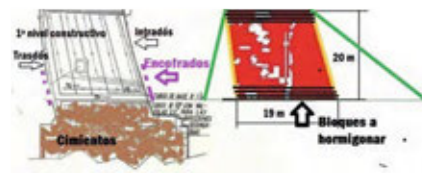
Sección del primer tramo construido. Recreación de los autores.
